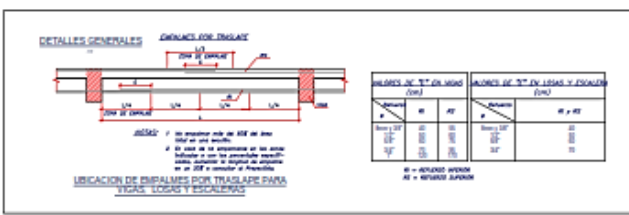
Plano Estructural. Aligerado del 2º nivel y detalle de vigas: E-05. Fuente: Propia (2018)
